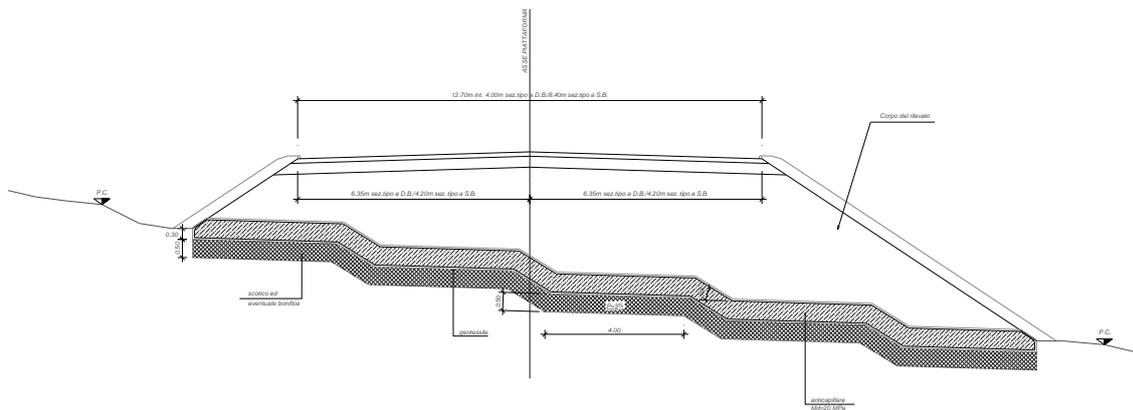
Strato di fondazione per rilevati con piano di posa inclinato  $p > 15\%$
